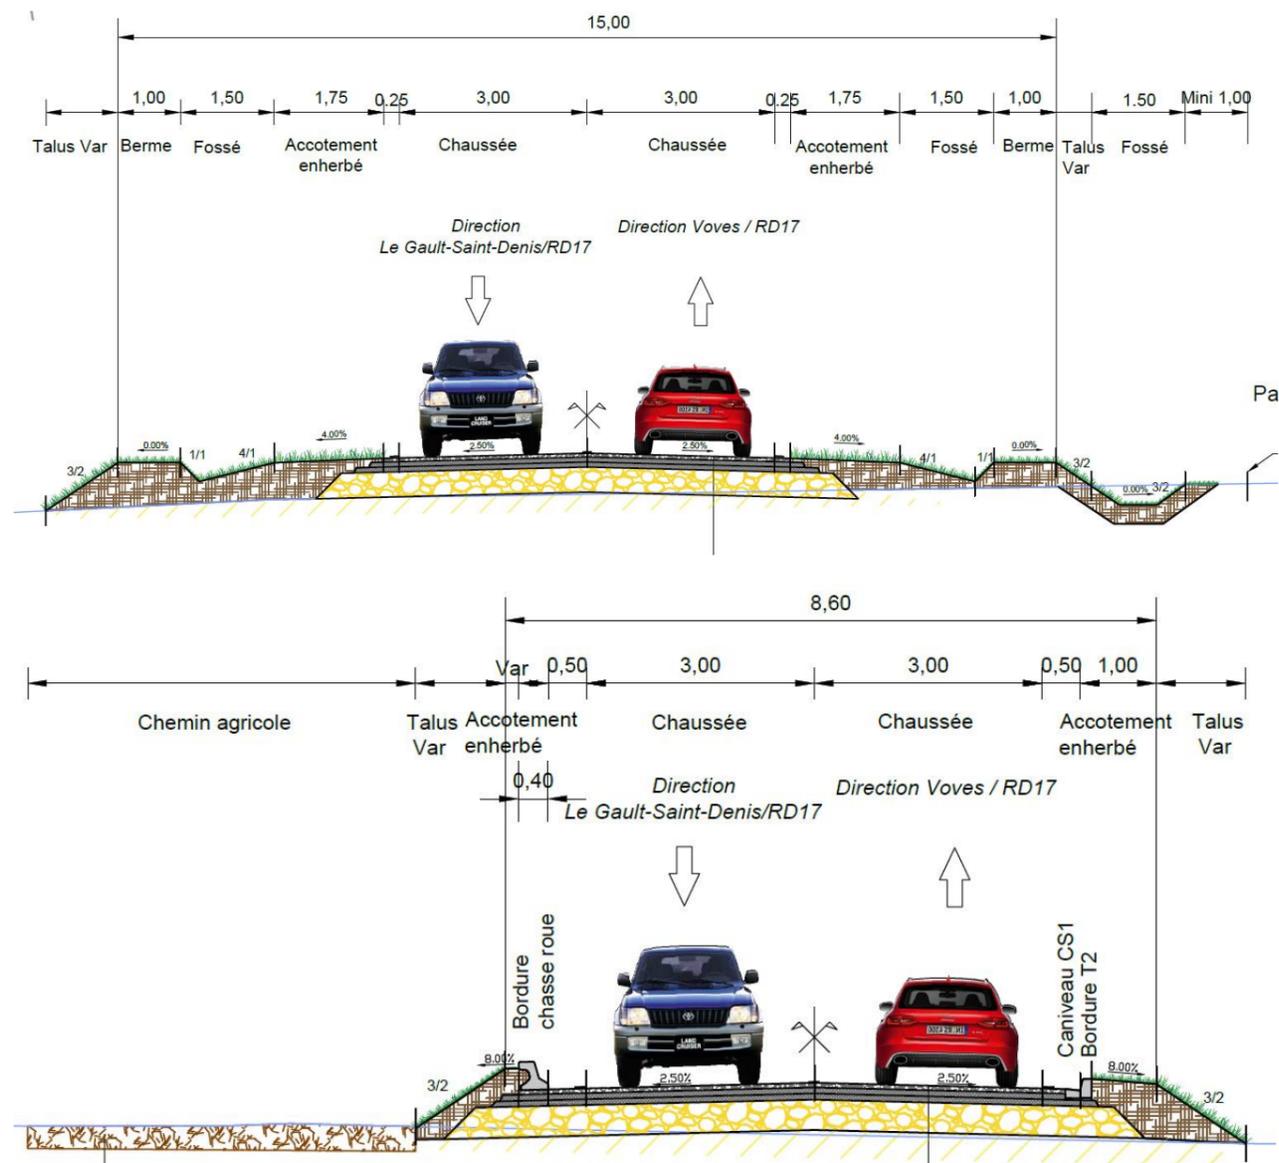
Profils en travers type de la voie nouvelle en section courante
